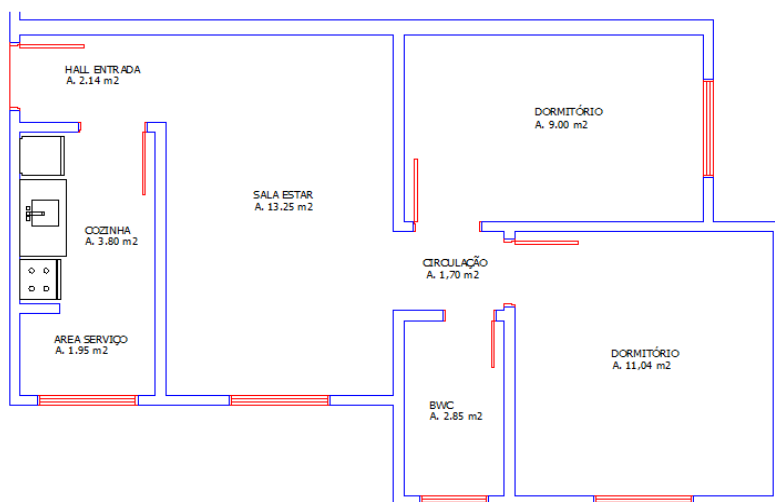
Planta baixa do apartamento tipo do Solar Buona Vita
